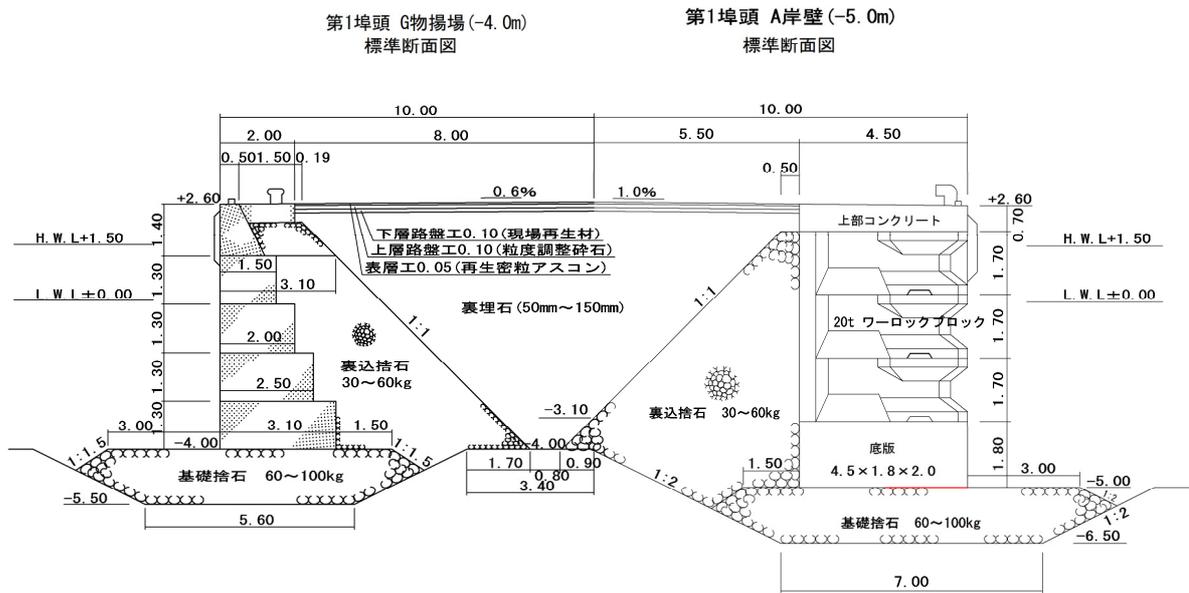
No.28 大洗港区_第1埠頭地区 A岸壁の断面図 (被災前)
